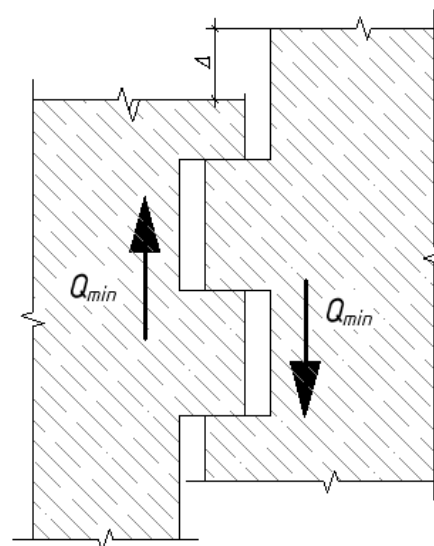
Расчетная схема вертикального стыка при сдвиге
